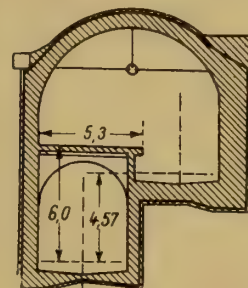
Haltestelle der Washingtonstraßen-Untergrundbahn in Boston
